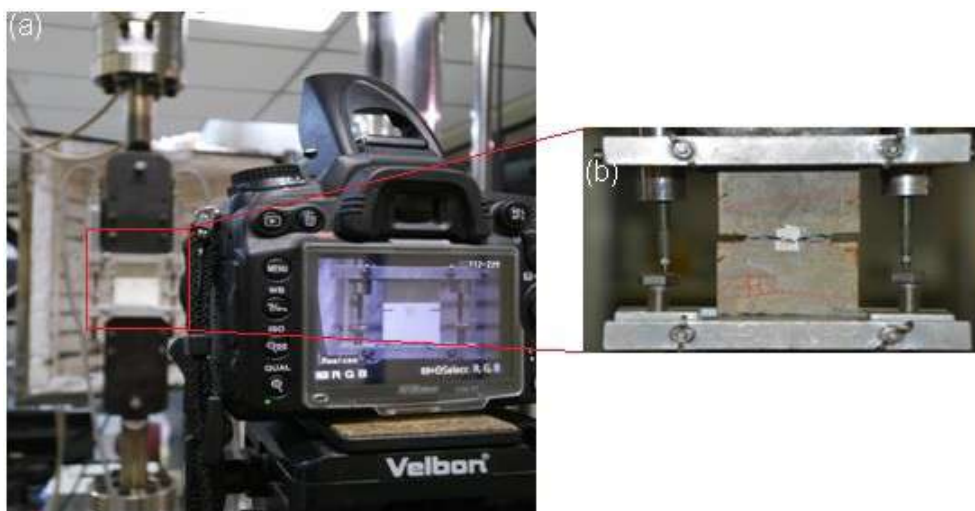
Configuração do ensaio de tração direta para indução da fissura, aos 28 dias: (a) ensaio, (b) detalhe do corpo de prova fissurado
